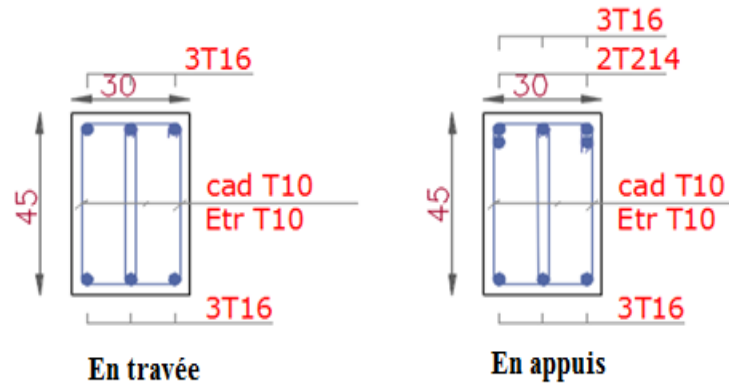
Schéma de ferrailage de poutre principale de voile (zone3)
